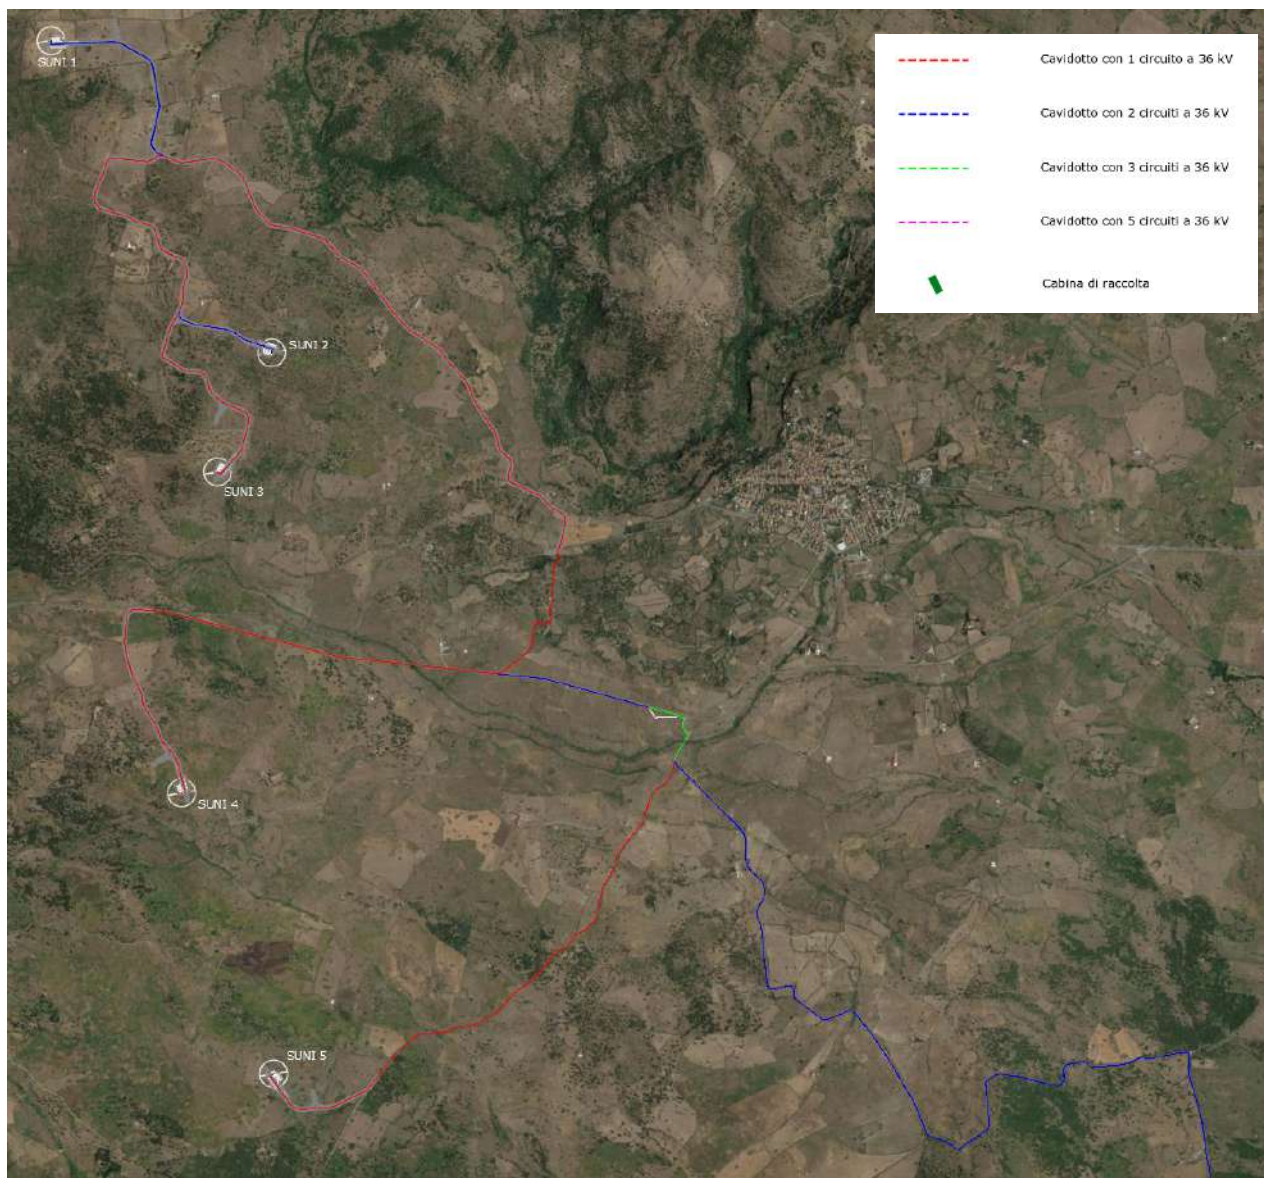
Vista in pianta dei cavidotti. Fonte: elaborato di progetto "C21BLN001DWD02900_ Planimetria cavidotti"
